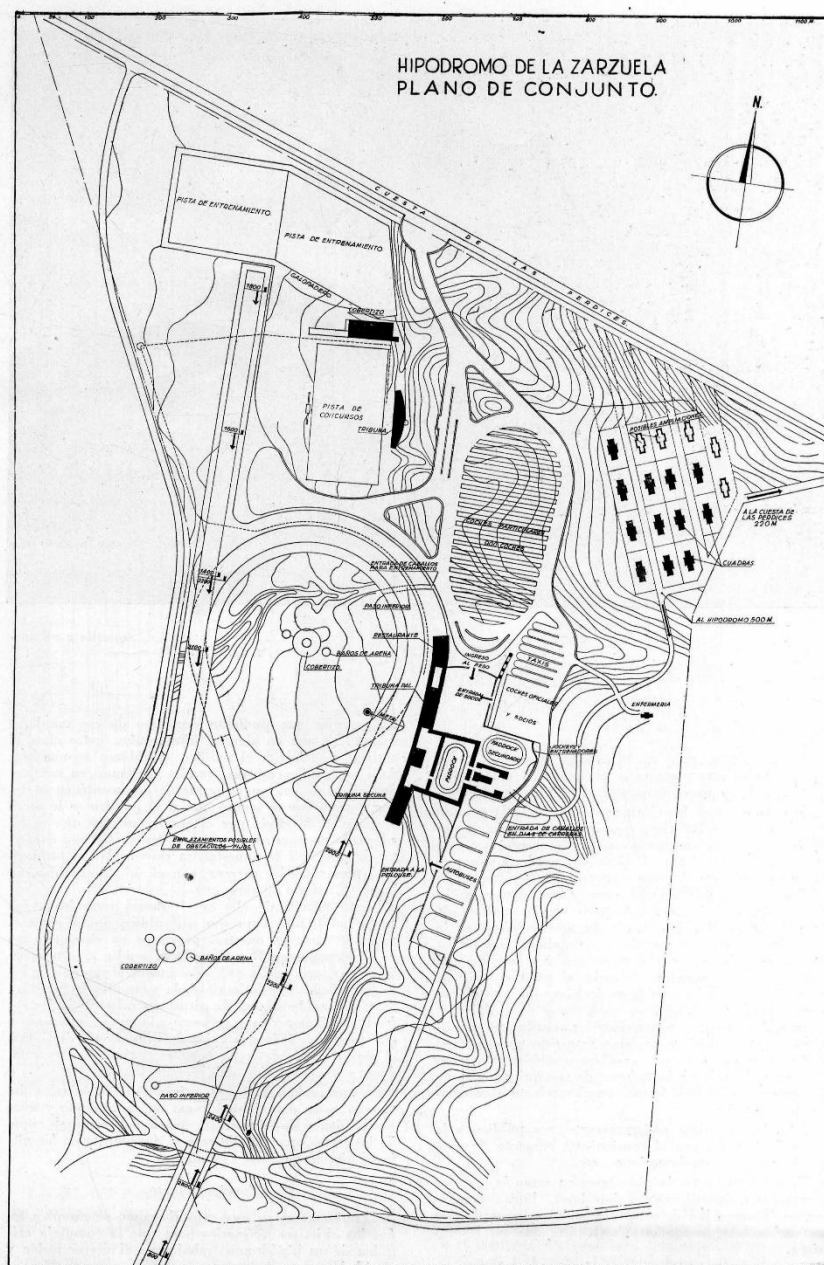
Planta general de la propuesta. (Fuente: Revista Nacional de Arquitectura, nº 81, 1948)
